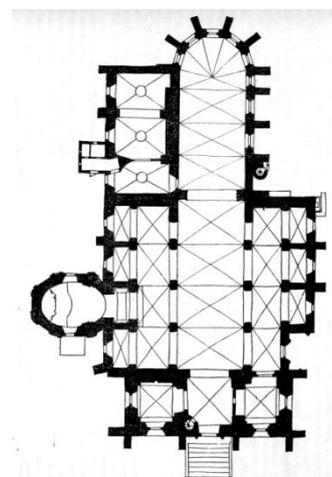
Trnava, Nikolauskirche, Grundriss, 1380-1448
